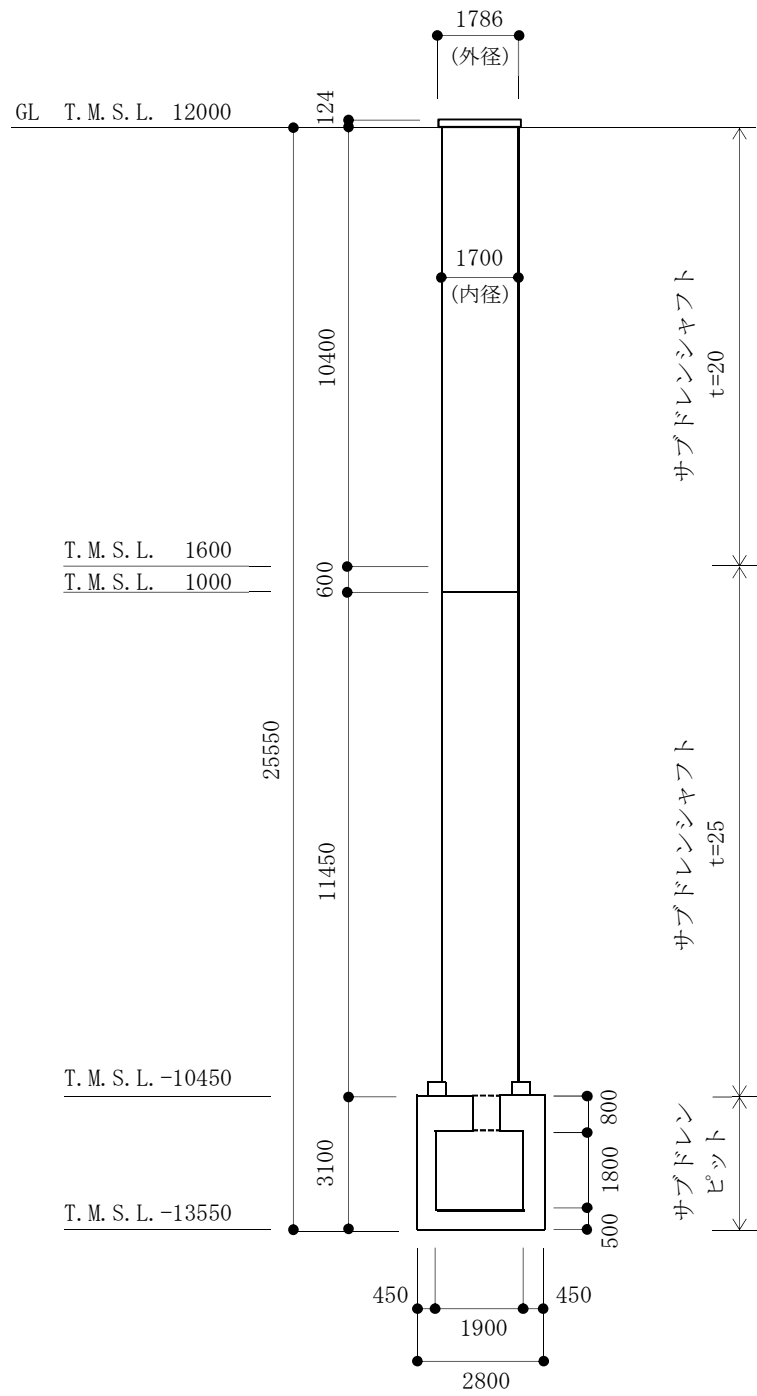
タービン建屋サブドレンシヤフトの概略断面図 (単位 : mm)
